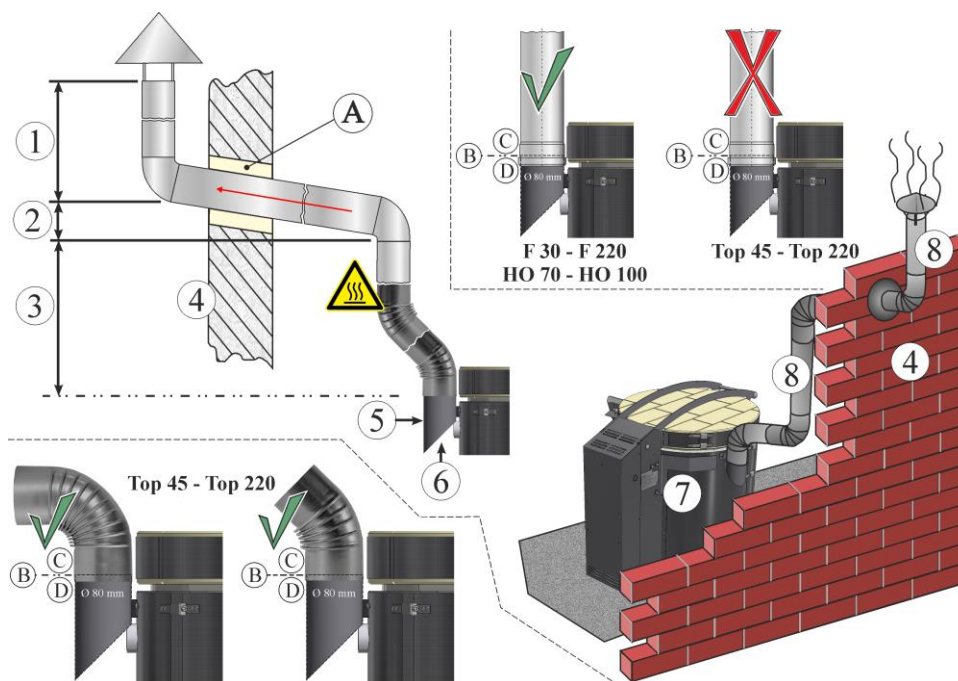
esempio: montaggio di una tubazione di scarico (illustrazione simile)
